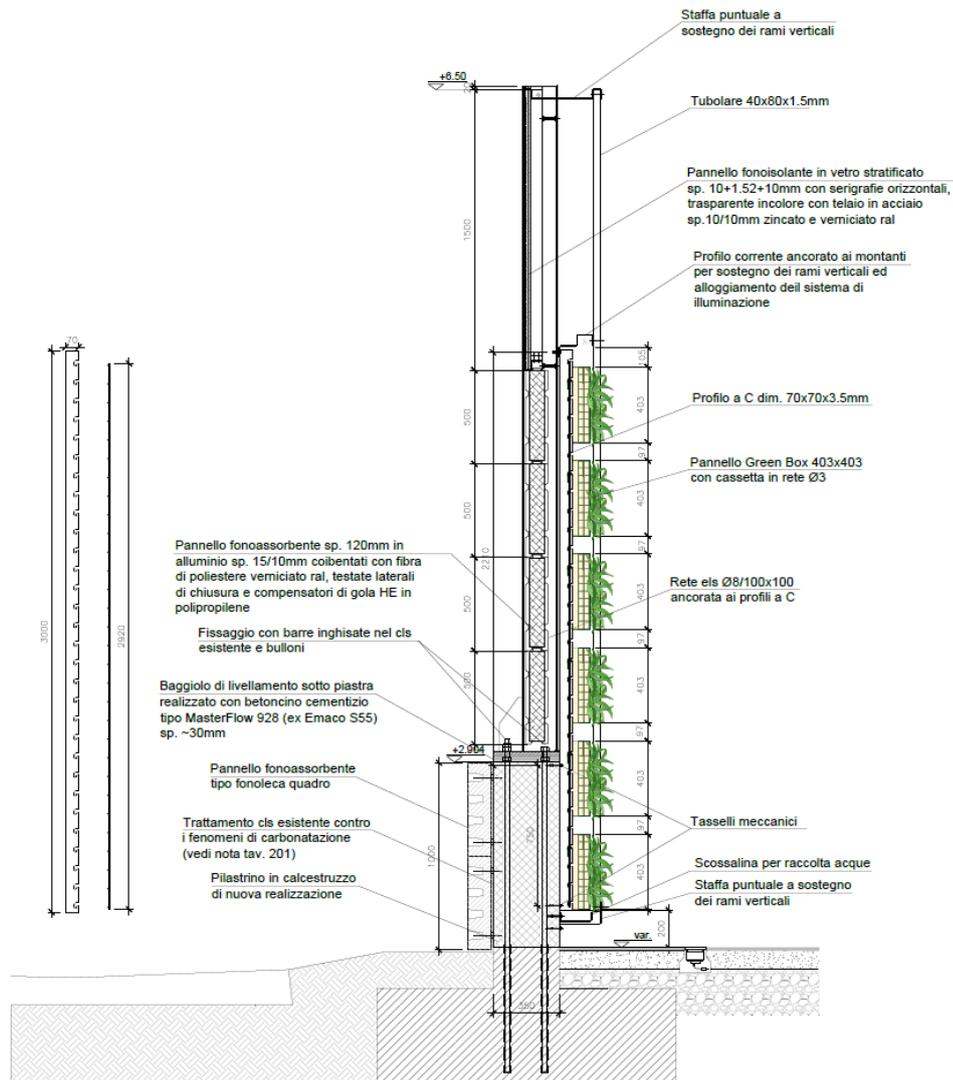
Progetto esecutivo - Protezione antifonica H=4,50 m, sezione tipo (A) – verde.
